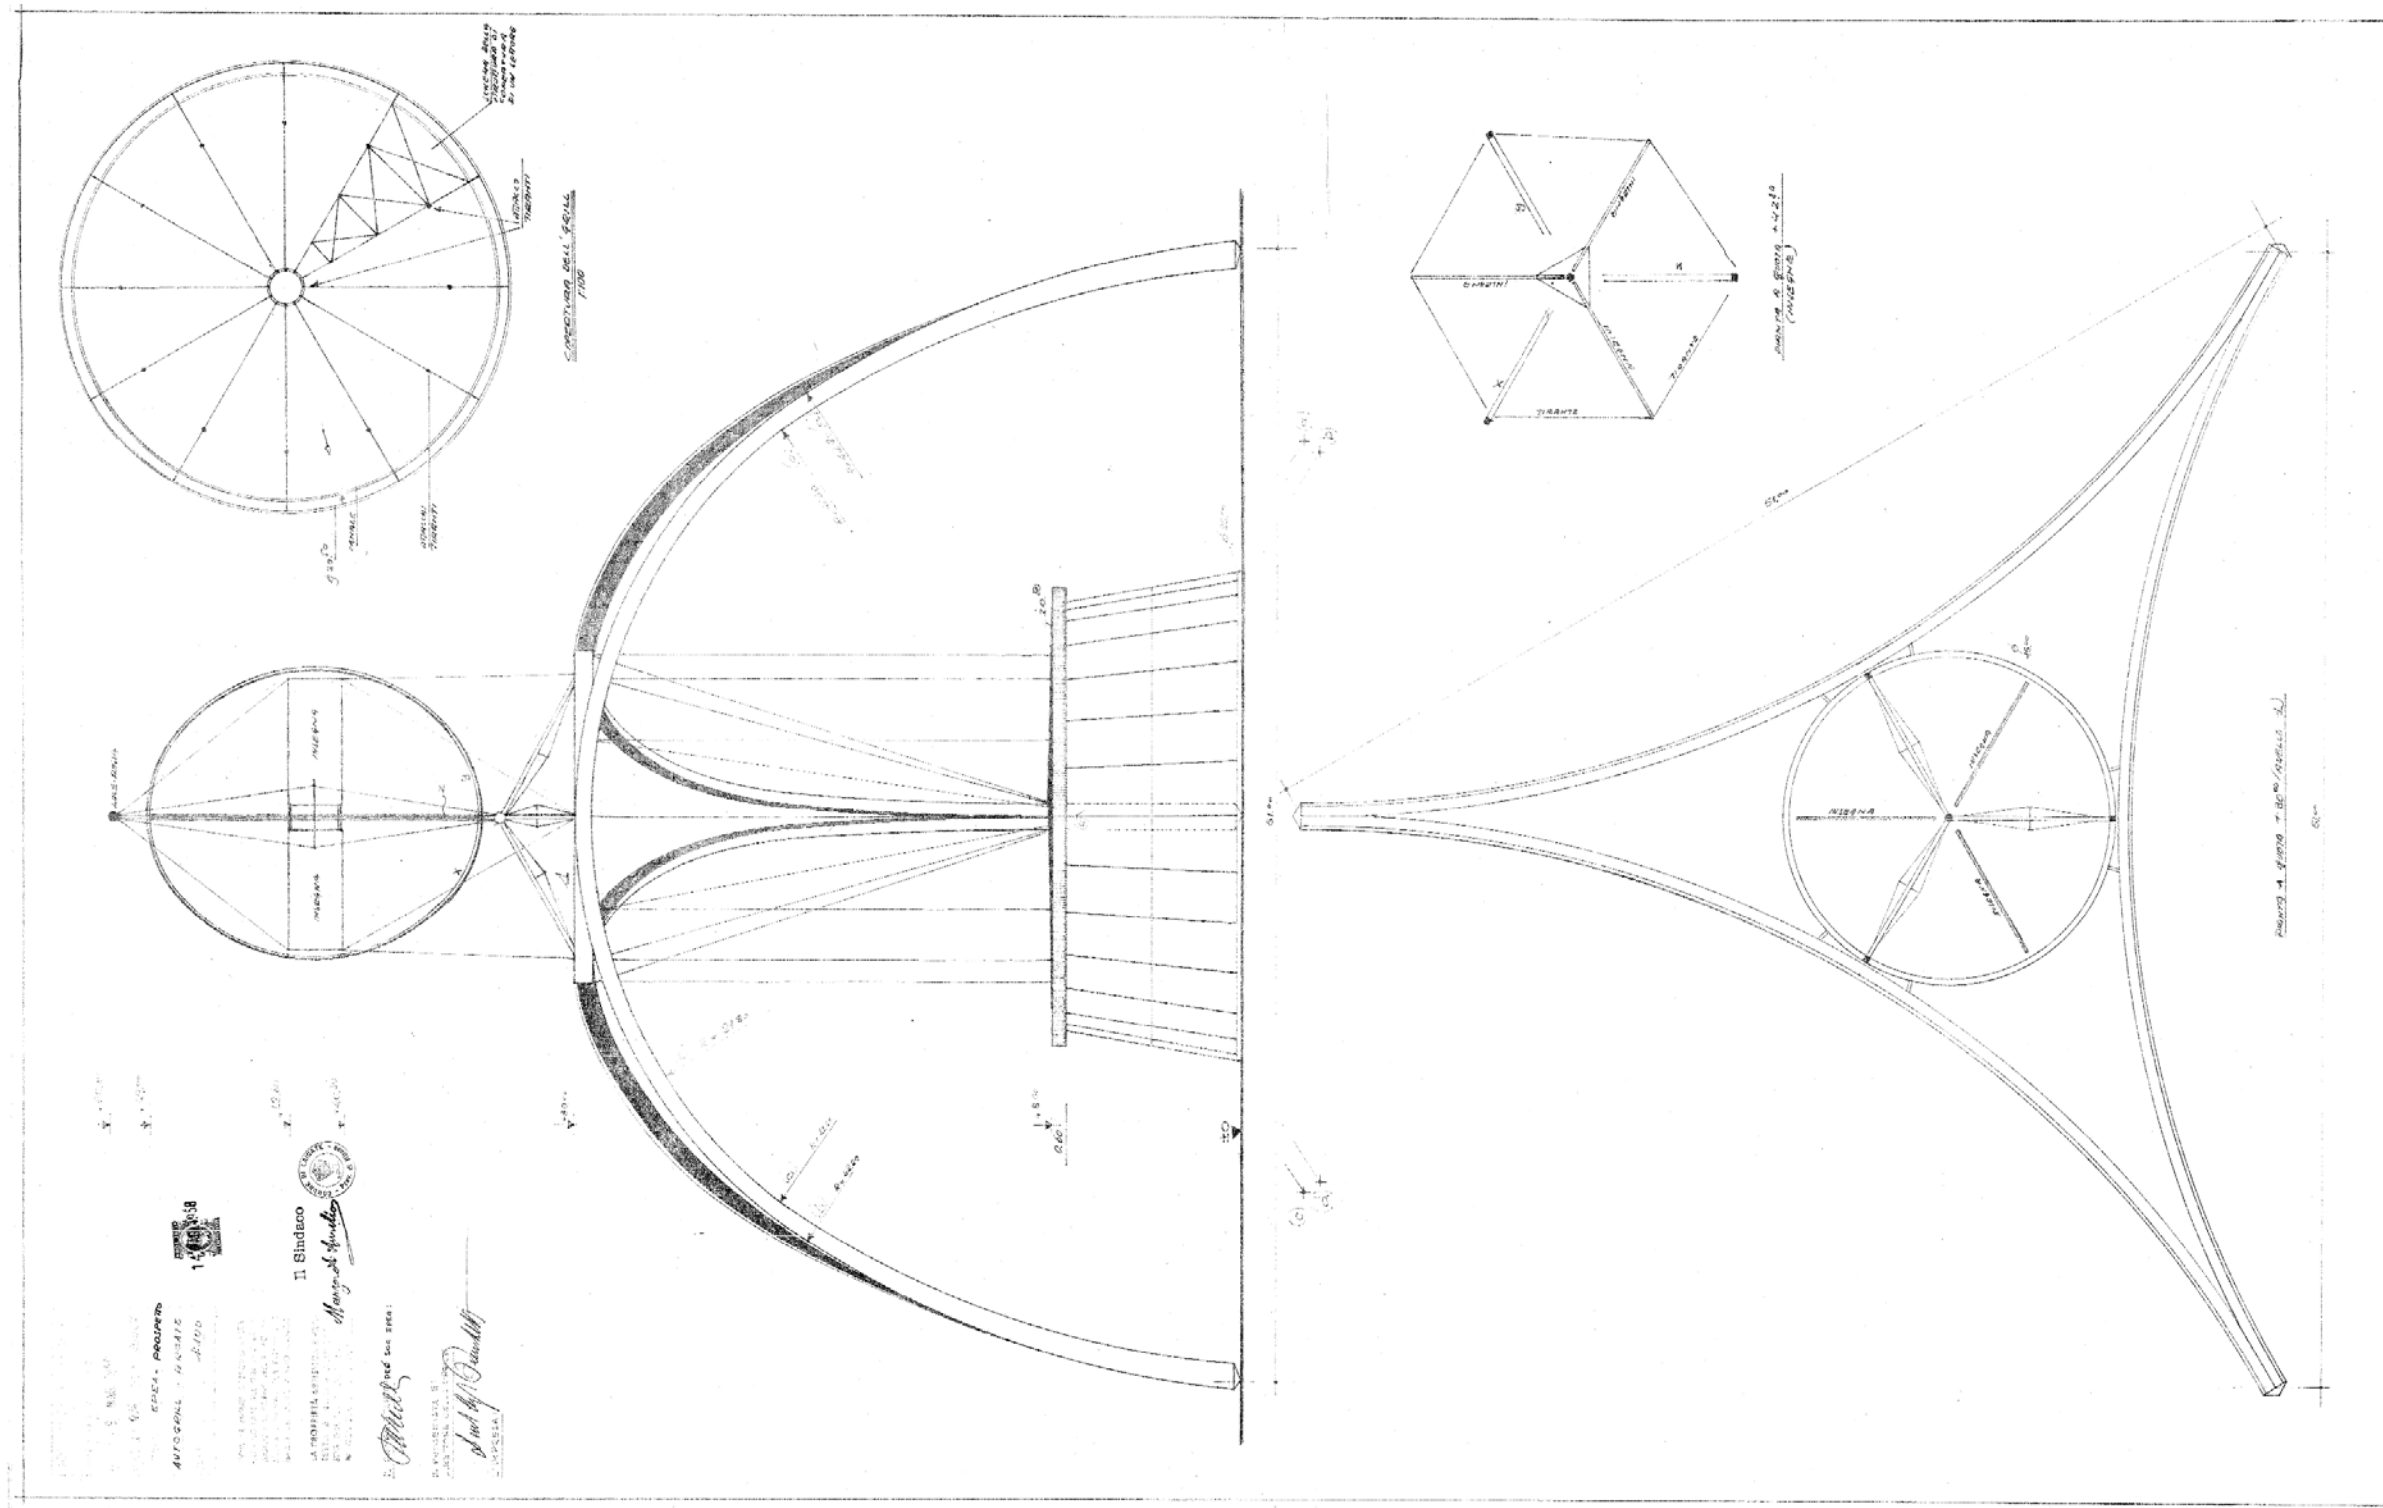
Prospetto e pianta delle arcate pubblicitarie in una prima ipotesi di progetto. (AAB). Nella fase esecutiva viene modificata sia l'orditura delle travi di copertura del padiglione che la posizione dei tiranti che completano l'installazione pubblicitaria.
